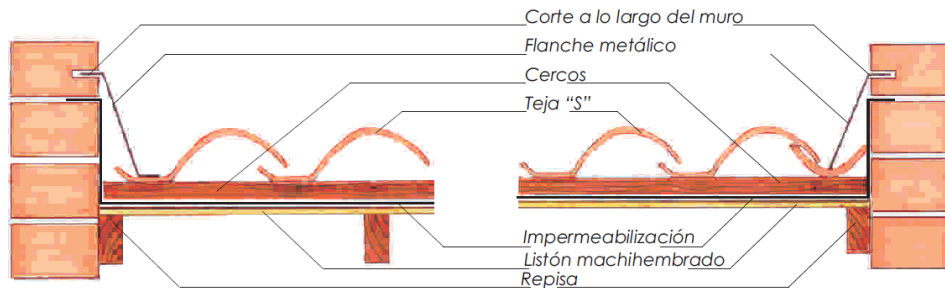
(Izquierda) Detalle remate teja "S" contra muro lateral, teja española y flanche instalado posteriormente. (Derecha) Detalle remate teja "S" contra muro lateral y flanche instalado posteriormente.
